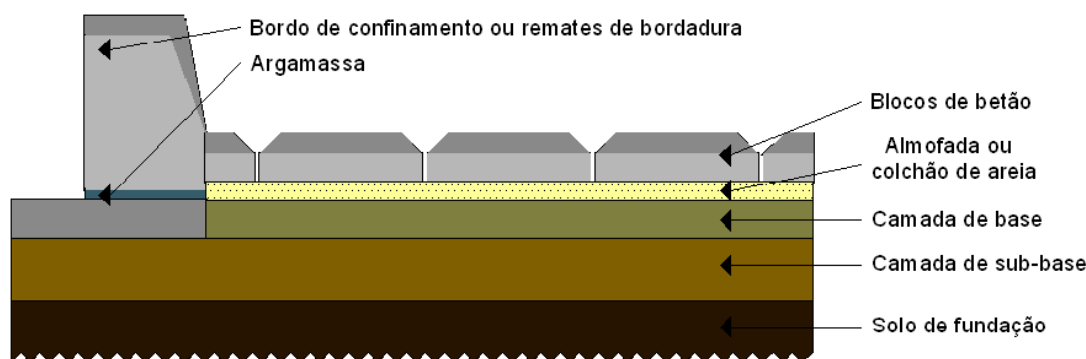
Estrutura tipo de um pavimento com blocos de betão (Morgado, 2008)
